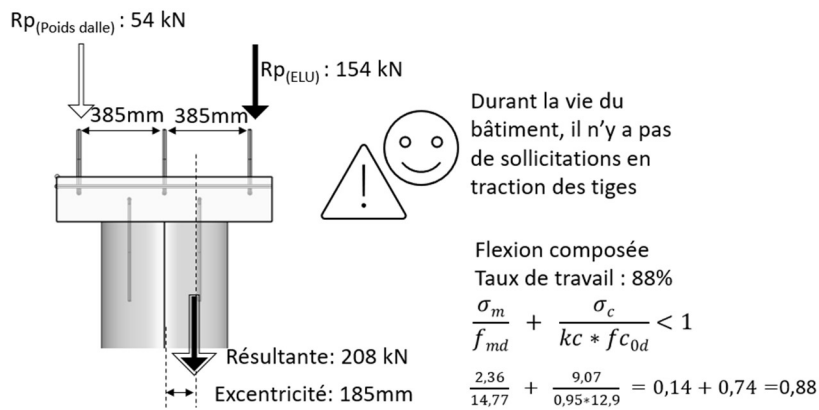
Détail de calculs : assemblage en console, pièce rapportée en béton
